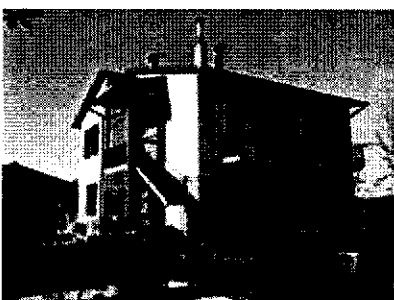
(edificio 11947) FOTO n° 50090 (edificio 11947) FOTO n° 50091 (edificio 11947)
